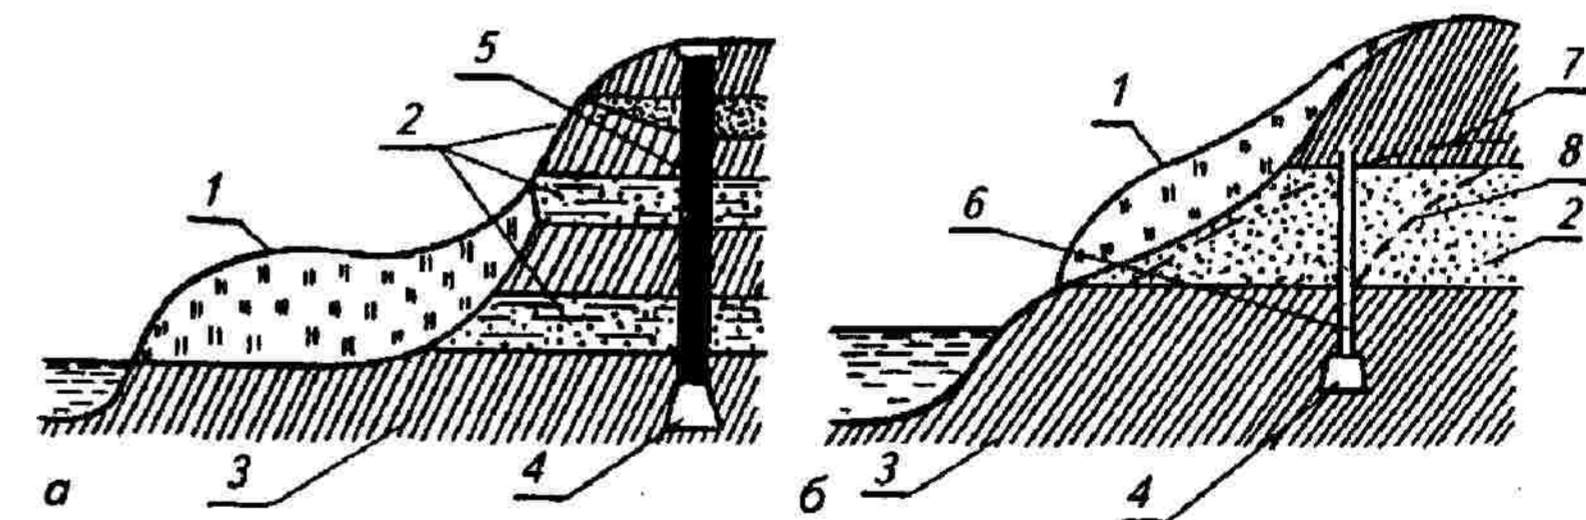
Схемы перехвата грунтовых вод (осушение откоса):
